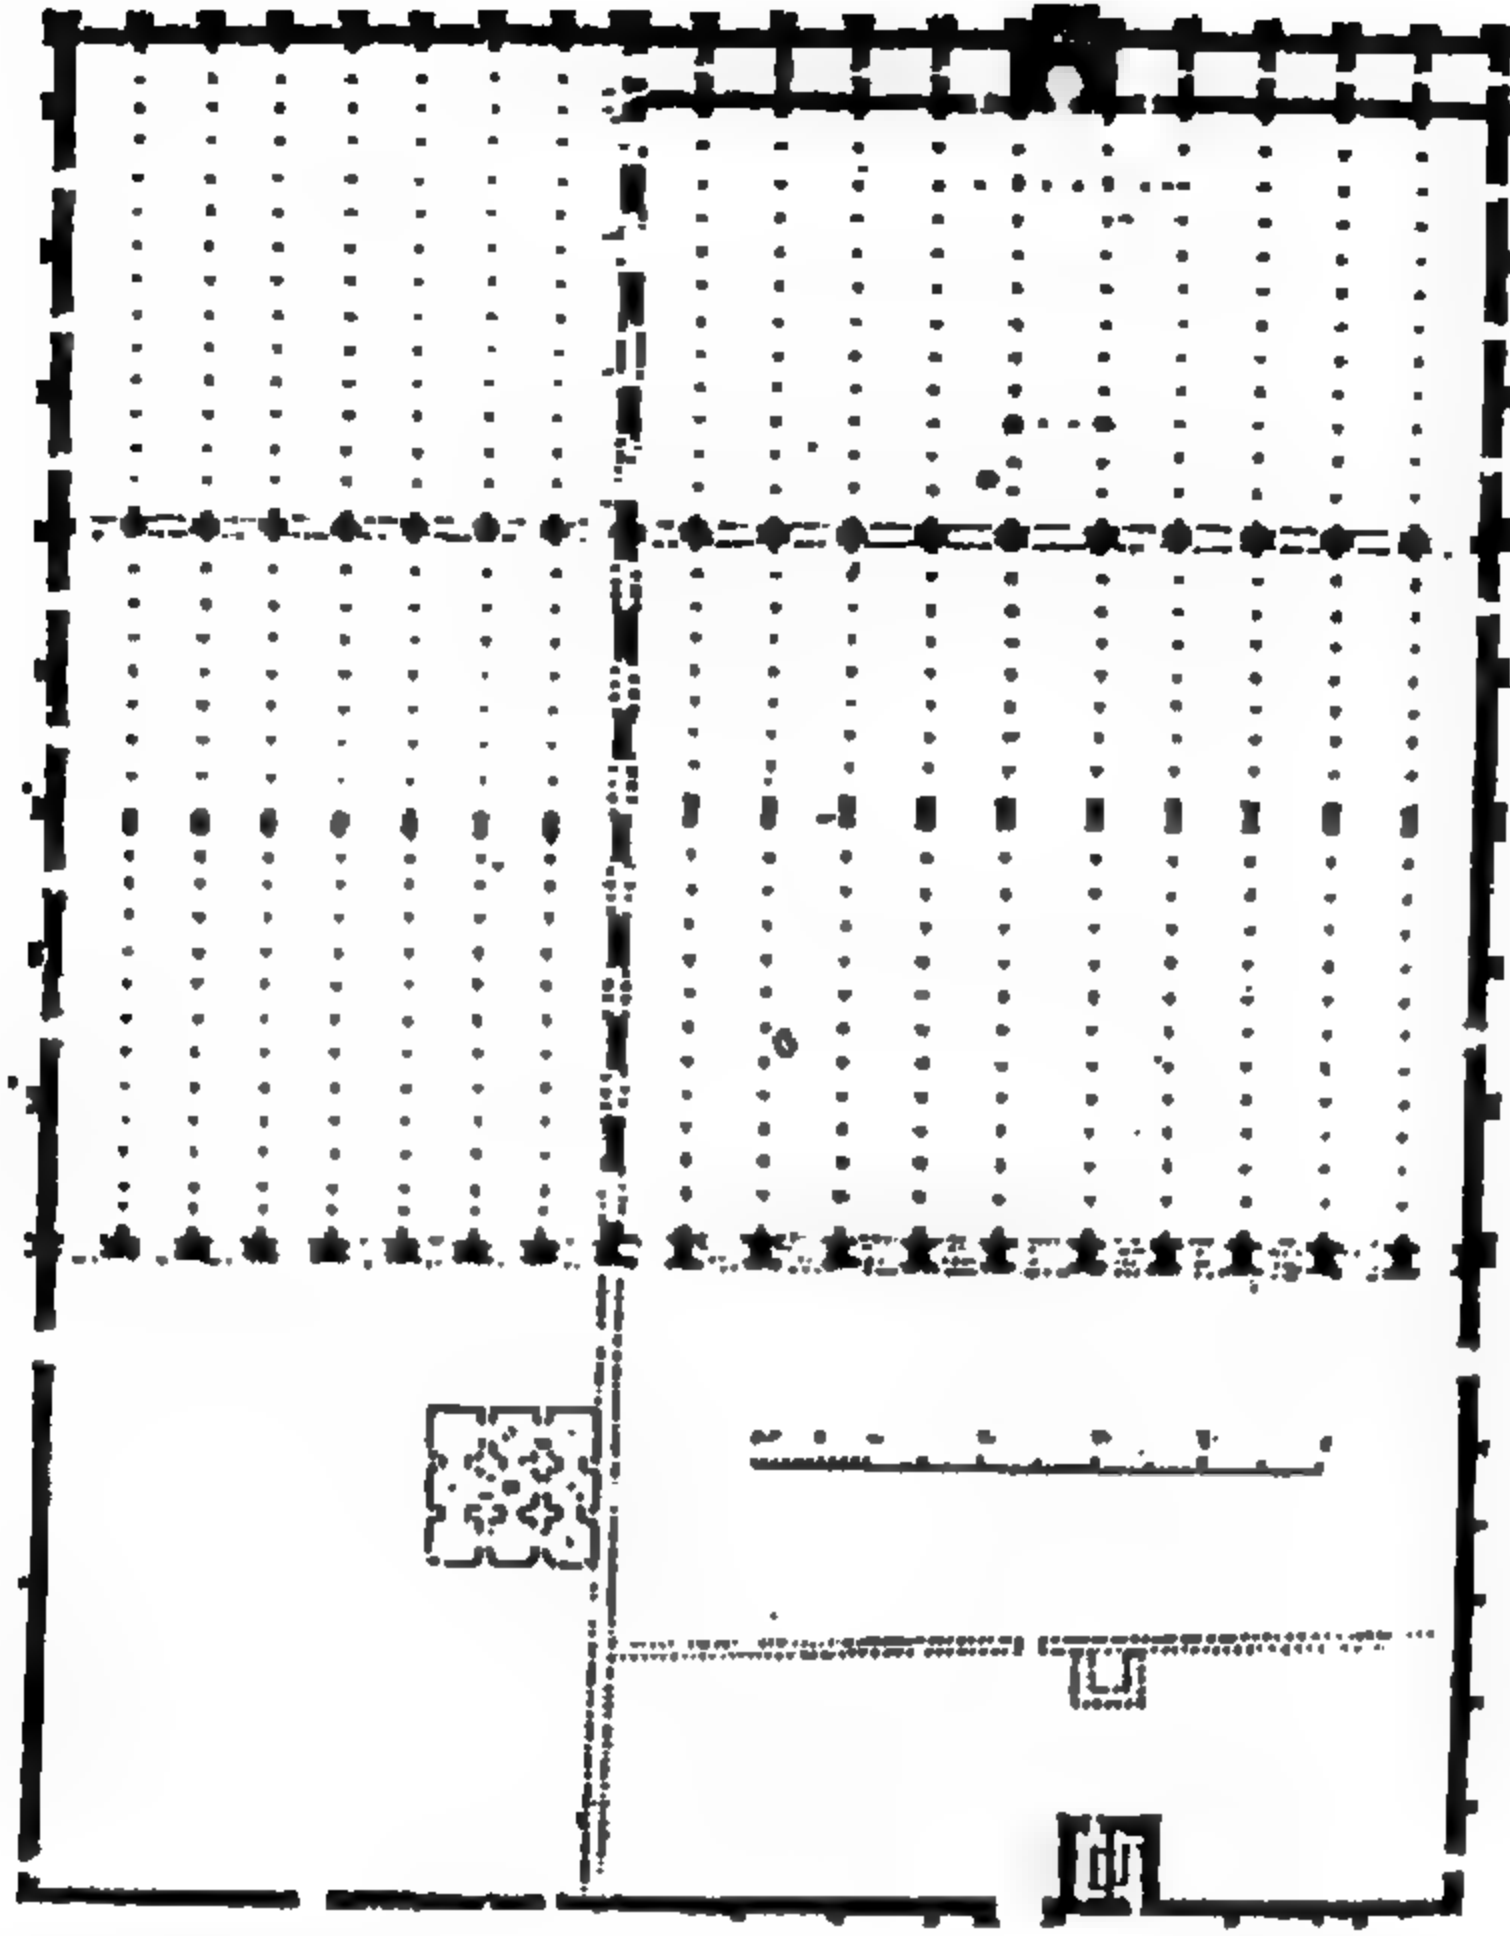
مسقط أفقي للجامع الأقصى الحالي
